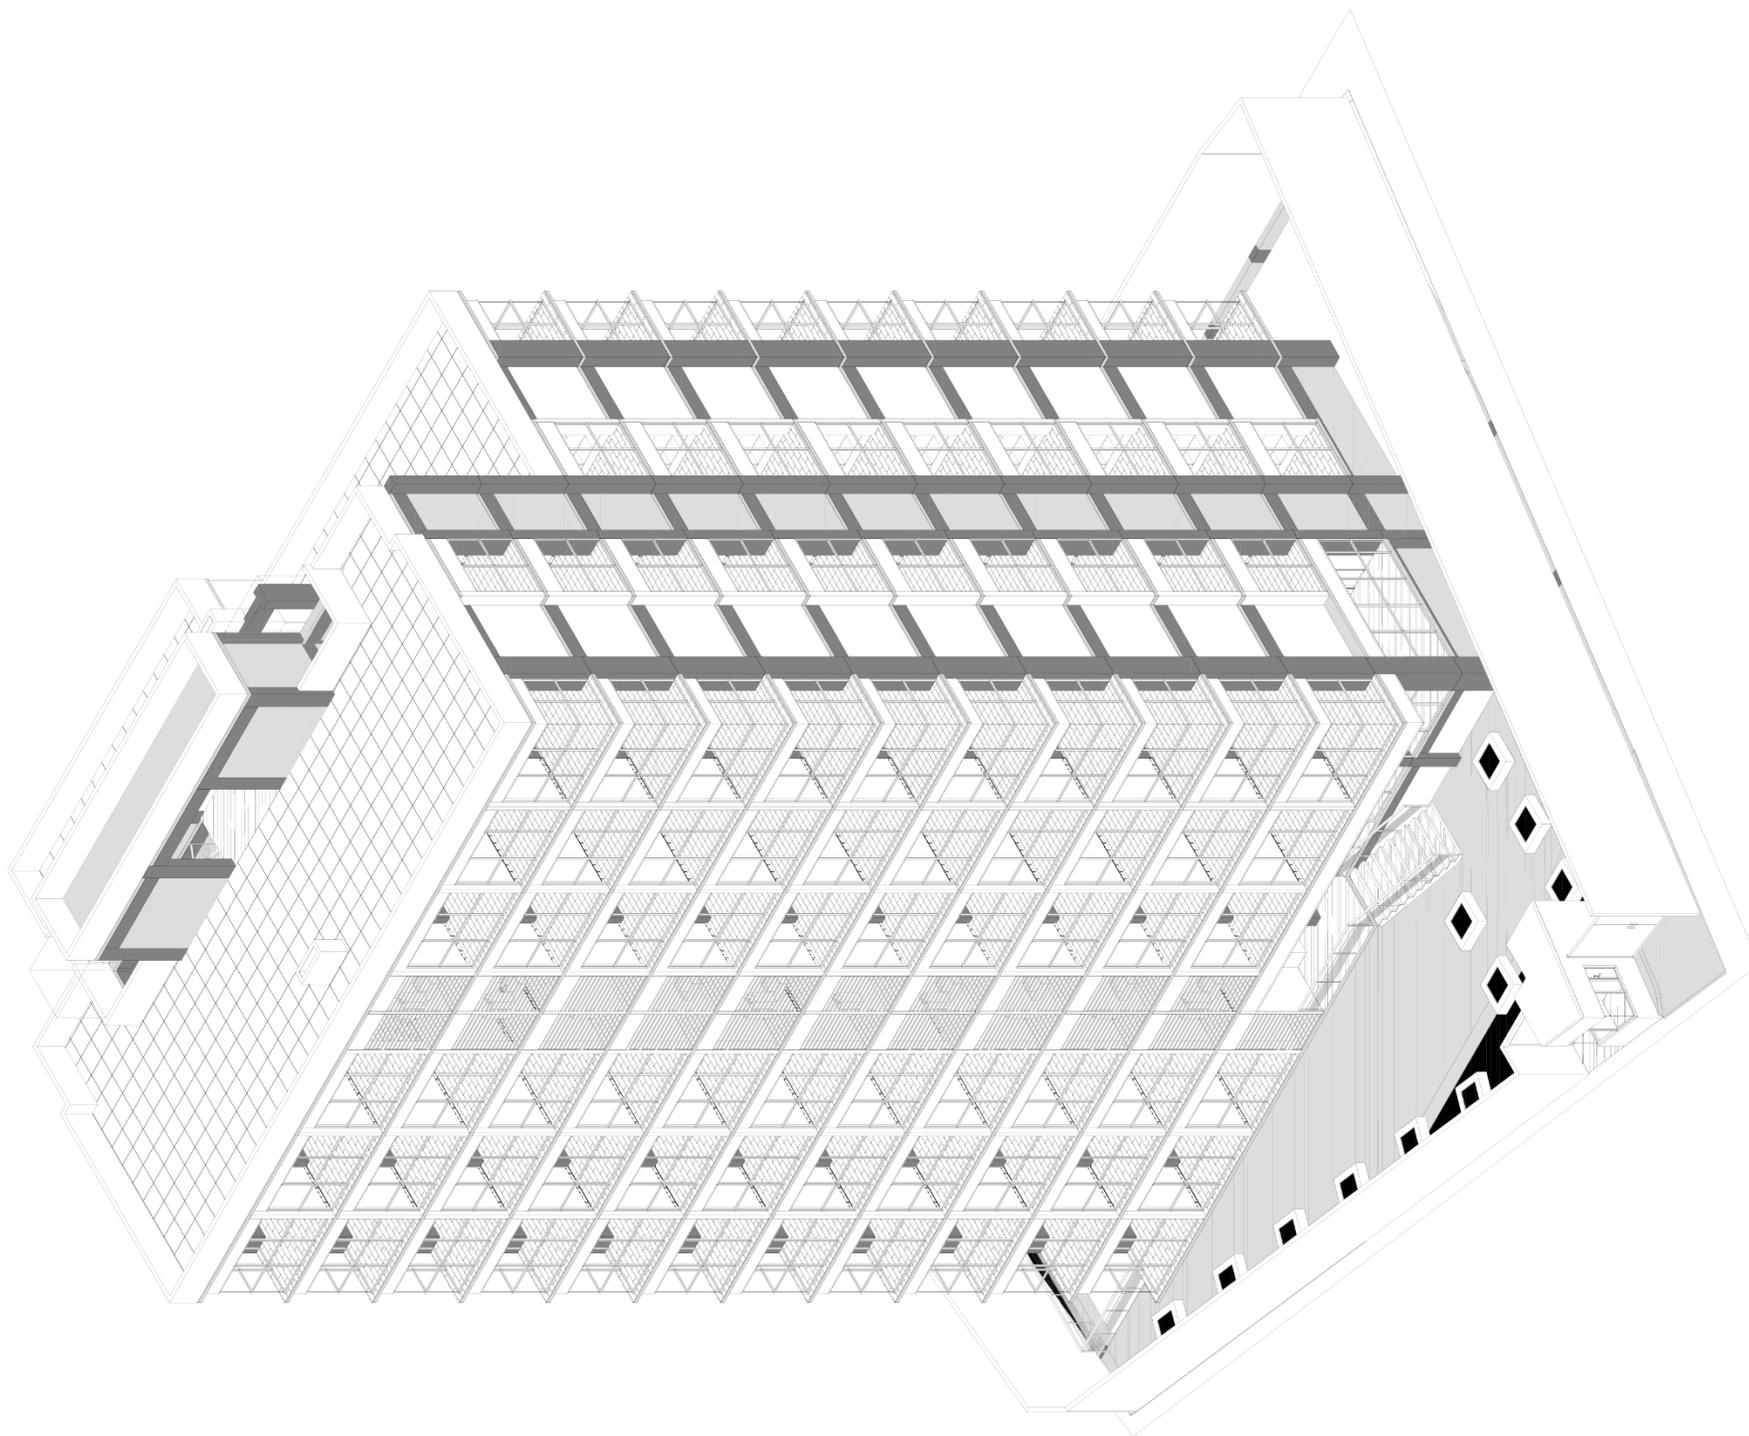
APUNTE PERSPECTIVO. Fachada principal y fachada norte
